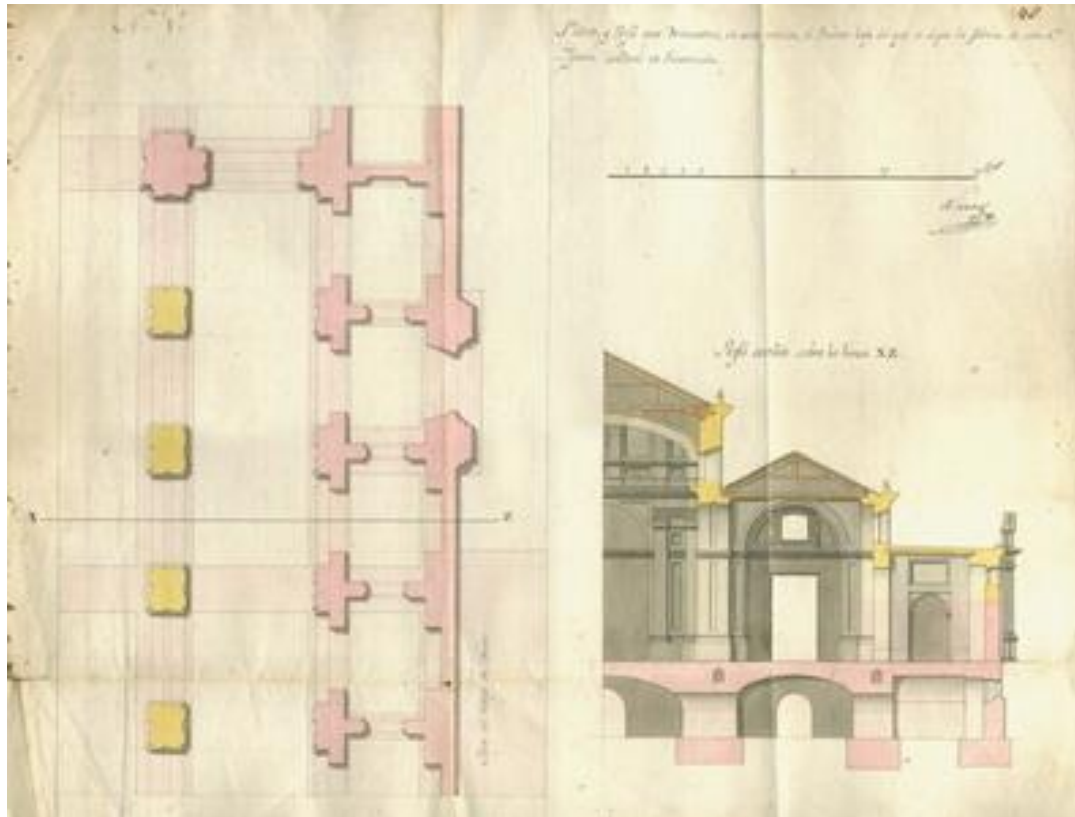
Planta y sección de la Catedral de 1792.<sup>2323</sup>
